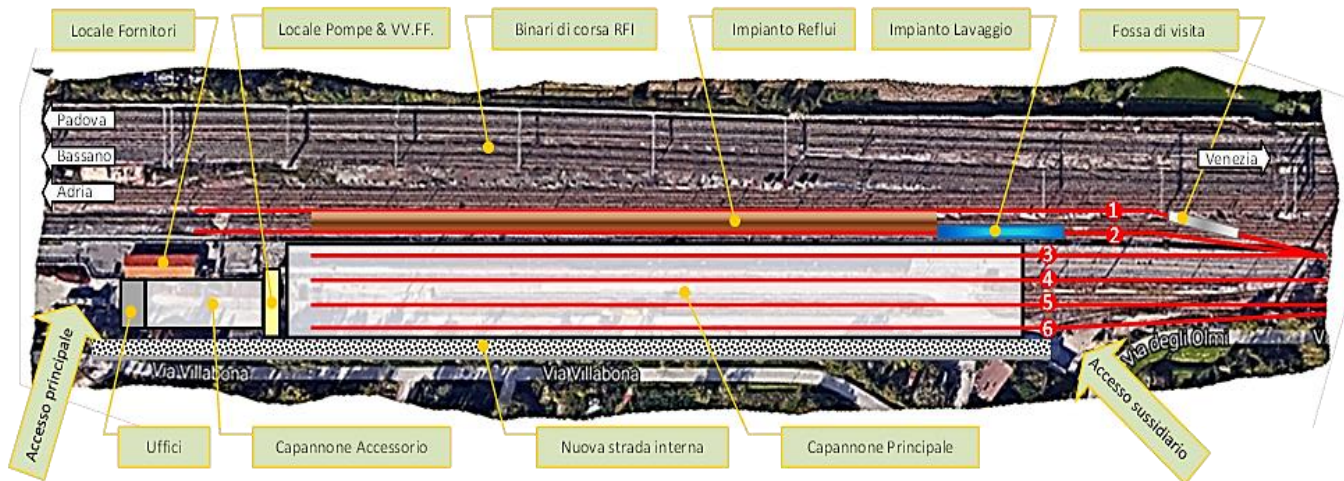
Centro di Manutenzione di Venezia Mestre - Planimetria schematica
